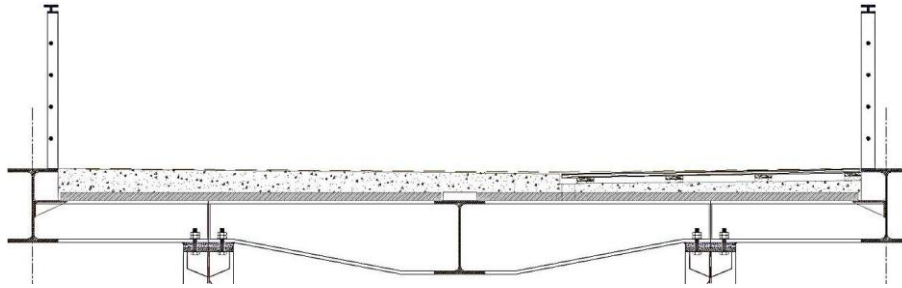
Secção transversal do tabuleiro da ponte na zona das carlingas correntes
